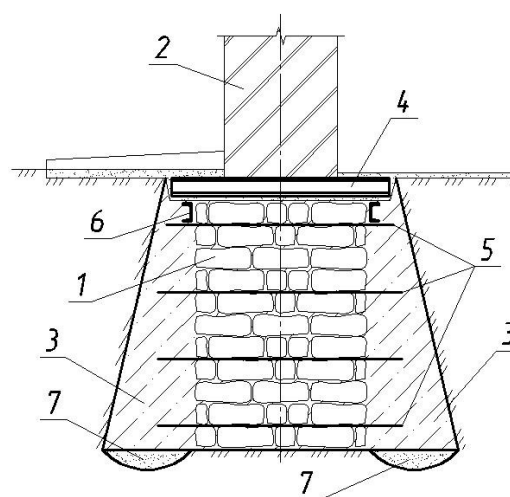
Посилення опорної площі улаштуванням приливів з бетону: 1 – посилюваний фундамент; 2 – цегляна стіна; 3 – приливи з бетону; 4 – металеві балки, встановлювані в пробиті отвори; 5 – металеві анкери з арматури; 6 – металеві балки, що закріплюються до поперечних балок; 7 – зони ущільненого ґрунту
